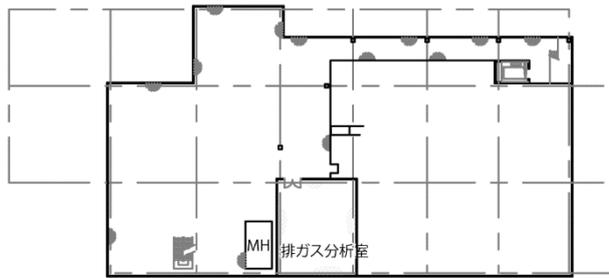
(7) 各階平面図 (計画施設：Ⅱ期)
